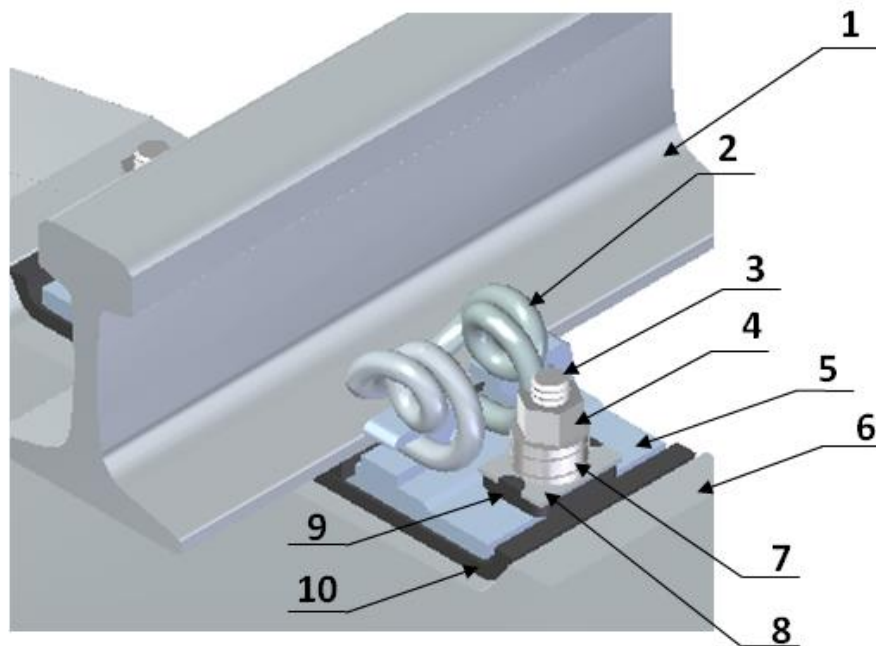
Конструкція вузла проміжного рейкового скріплення типу КБ(У)
